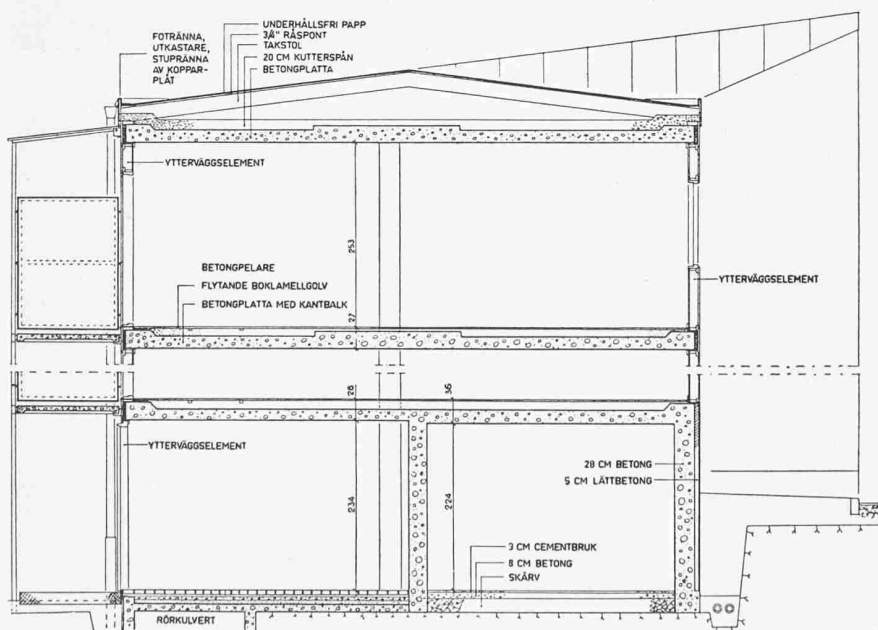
Schnitt. Erdgeschoss und 5. Obergeschoss, Masstab 1:100. (Das Gebäude ist nicht unterkellert.) Uebersetzung: Ytterväggselement = Aussenwandelement, Betongpelare = Betonpfeiler, Flytande Boklamellgolv = Schwimmender Buchenlamellenboden, Betongplatta med Kantbalk = Betonplatte mit Randbalken, Lättbetong = Leichtbeton.
